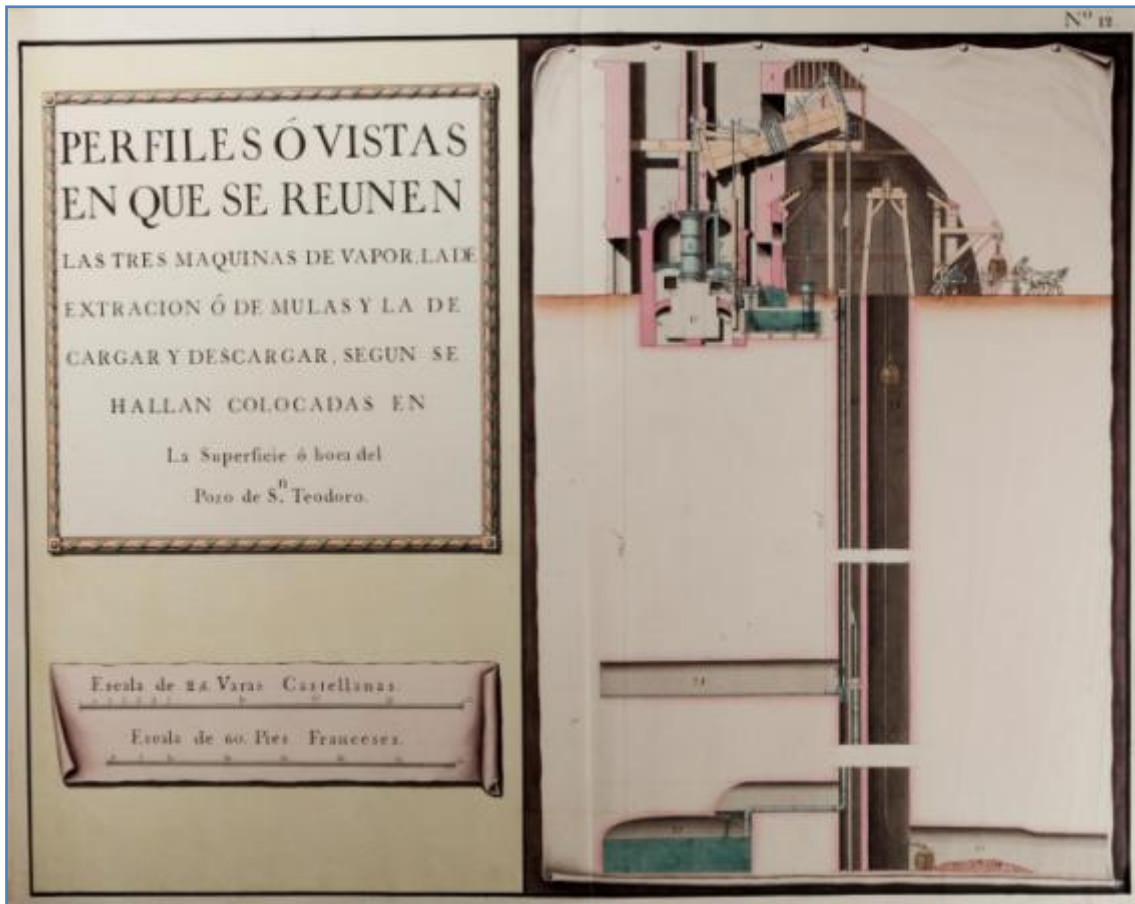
Plano de las tres máquinas del pozo de San Teodoro.
